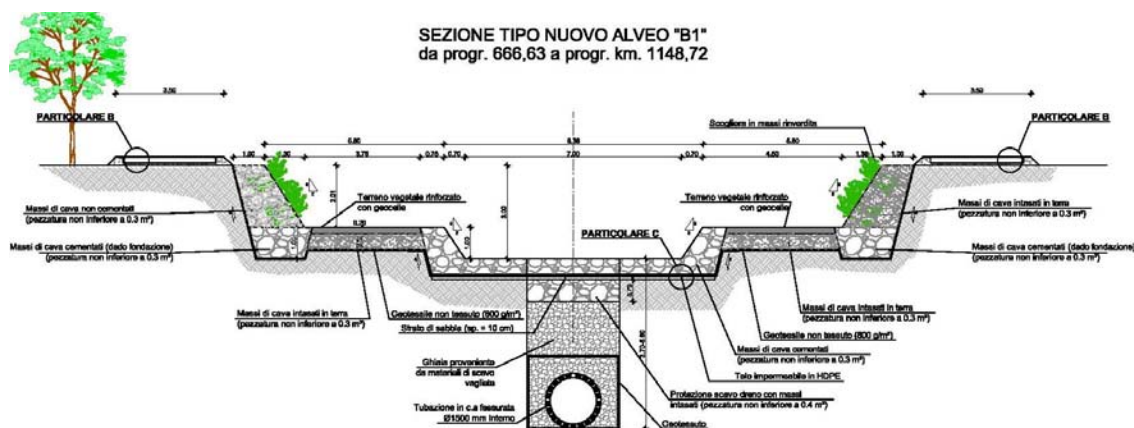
Sezione dreno in tratto coincidente con il T. Marmazza
